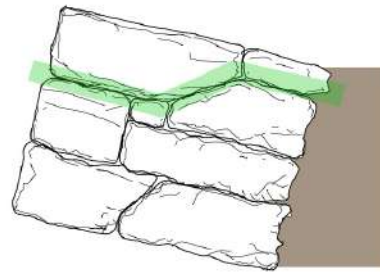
Verifica dell'inclinazione del piano di attesa di una pietra di fondazione per mezzo della bolla
